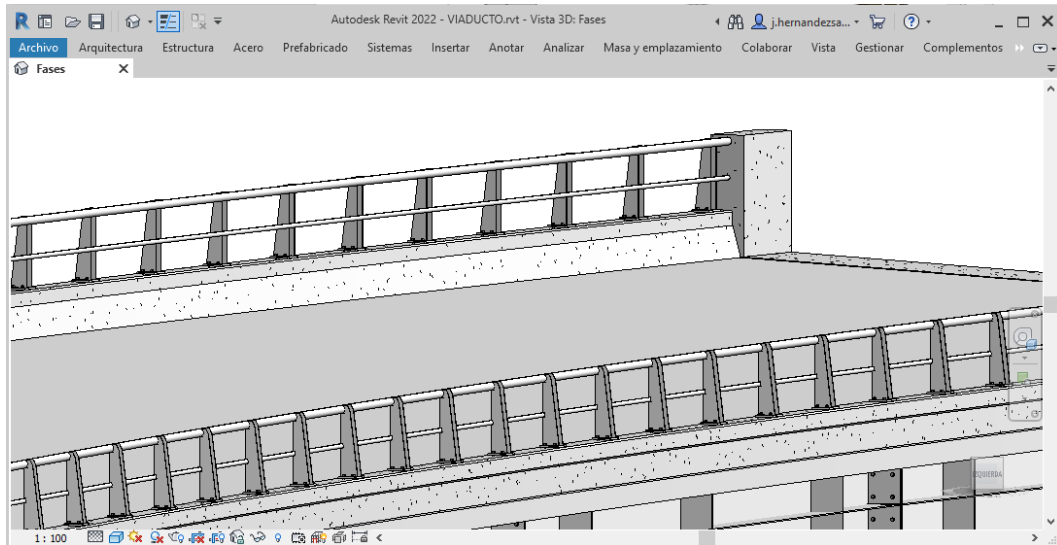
Modelado de pilastras del Parapeto. Fuente: Elaboración propia
